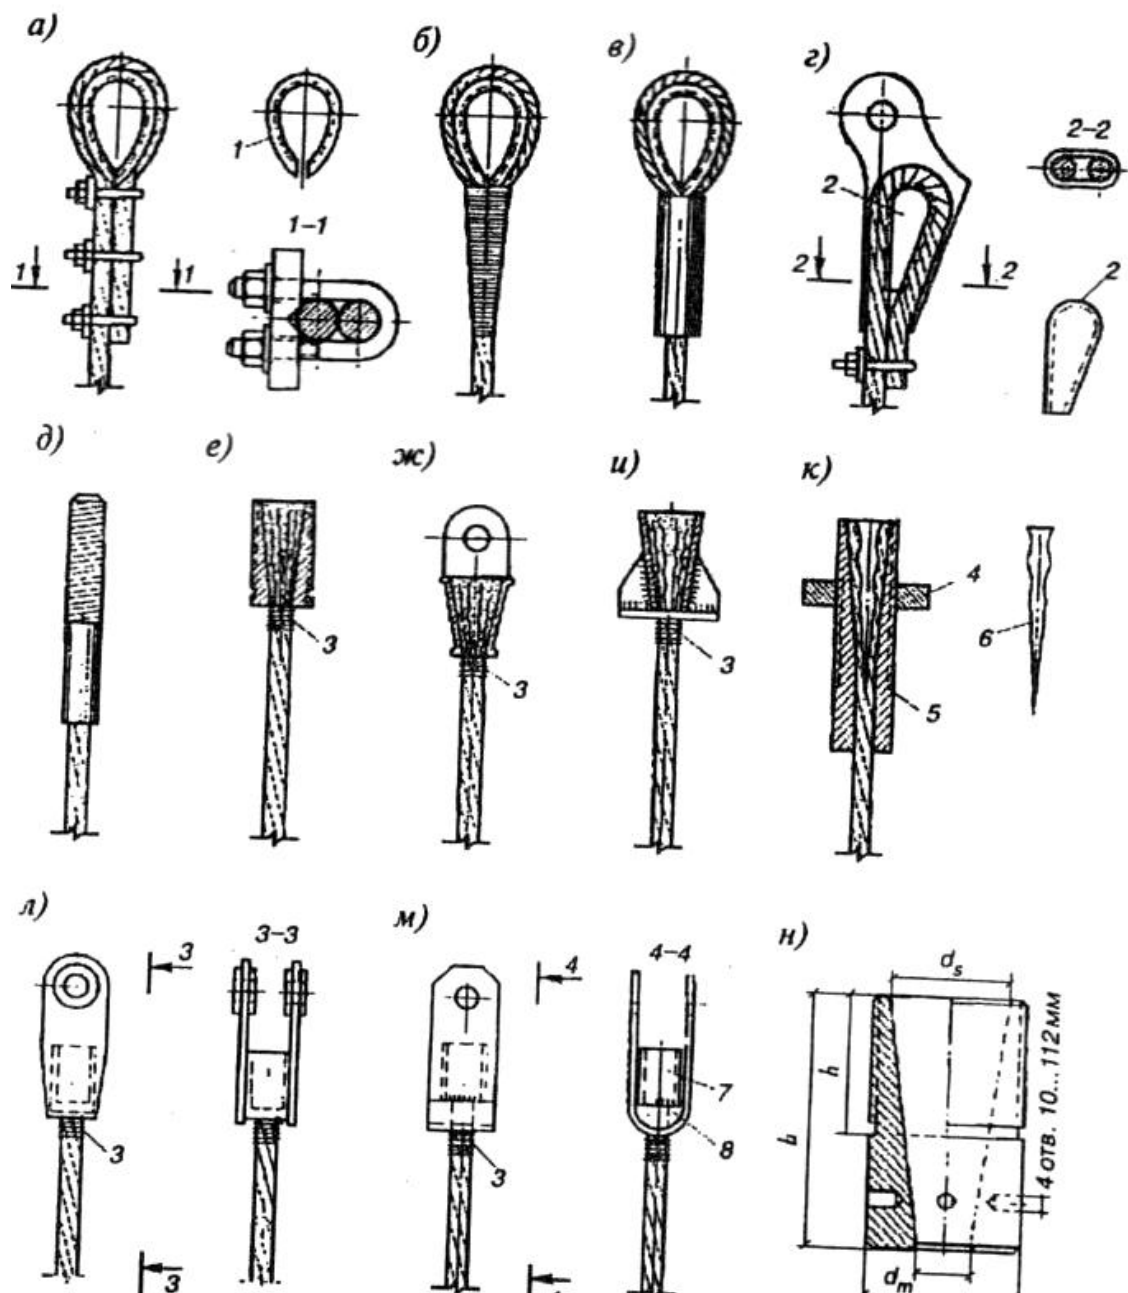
Концевые крепления канатов тросовой конструкции: а – петля с коушем на зажимах; б – петля с вплетённым коушем; в – петля с коушем и запрессовкой; г – самозаклинивающийся зажим; д – запрессованная втулка; е – заливной натяжной стакан; ж – заливной шарнир; и – заливной упор; к – гильзоклиновой анкер; л – заливной стакан со сварной скобой; м – то же с гнутой; н – заливной стакан; 1 – коуш; 2 – подвижной клин; 3 – мягкая вязальная проволока; 4 – опорная гайка; 5 – гильза из мягкой стали; 6 – фасонный клин; 7 – круглый или квадратный стакан; 8 – гнутая скоба
